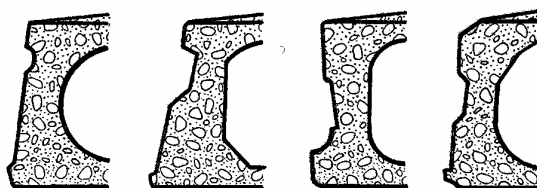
Perfis típicos de juntas para elementos de laje alveolares
